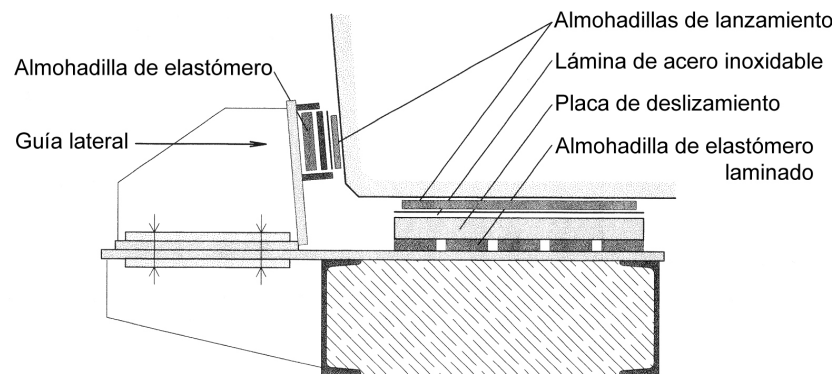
Sección transversal de un apoyo de lanzamiento con guía lateral [F15 y elaboración propia]
